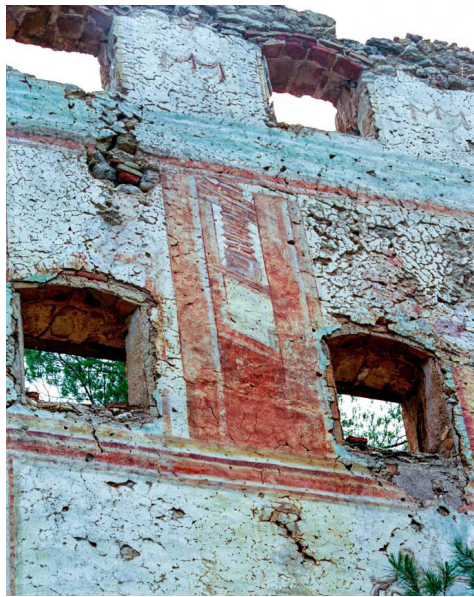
Detalle de las pinturas de las fachadas de la fábrica
